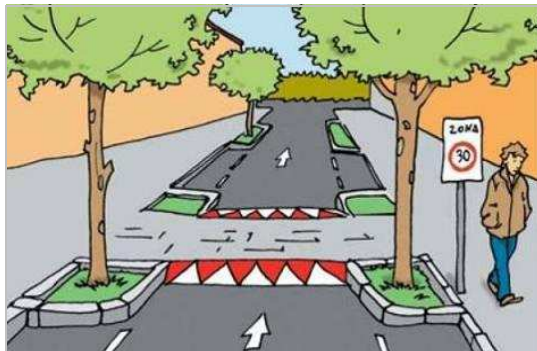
Cambio de pavimento en entradas a áreas 30
